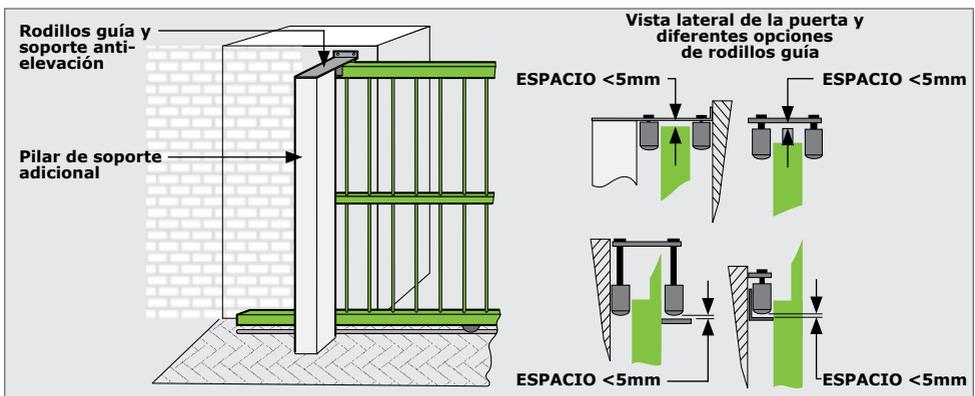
MONTAJE DE RODILLOS GUÍA
